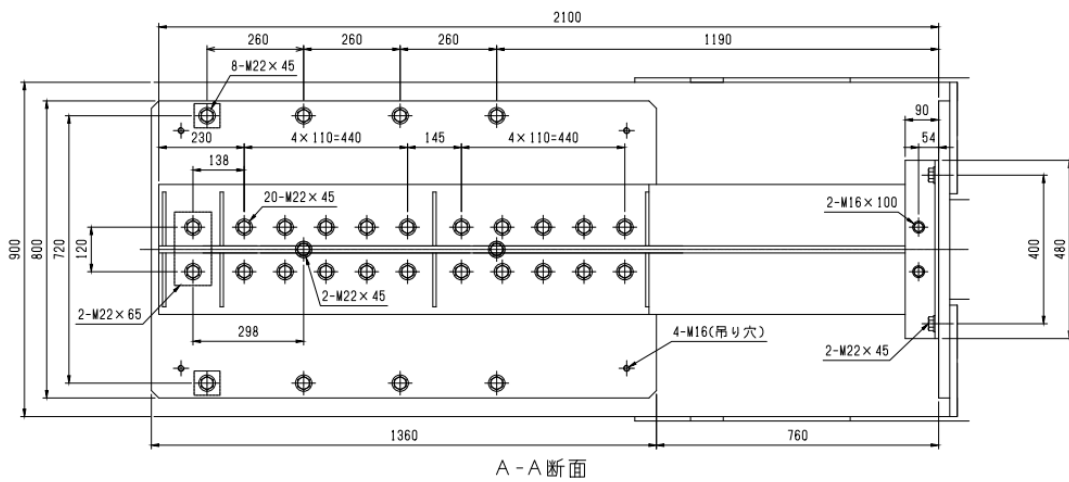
ケース 1 の試験体設置後 上面図(単位 : mm)
